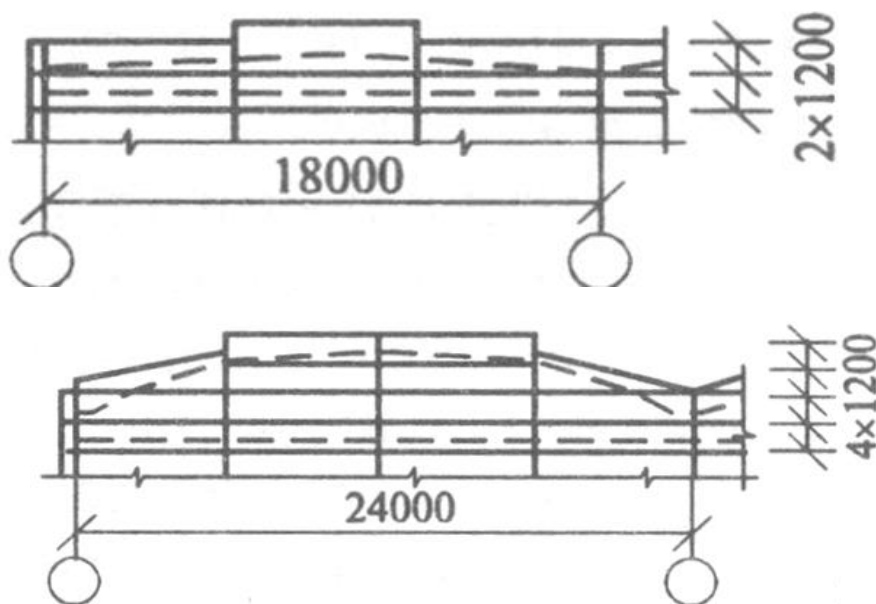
Схема раскладки панелей по условиям унификации в торцевых стенах одноэтажных зданий;
